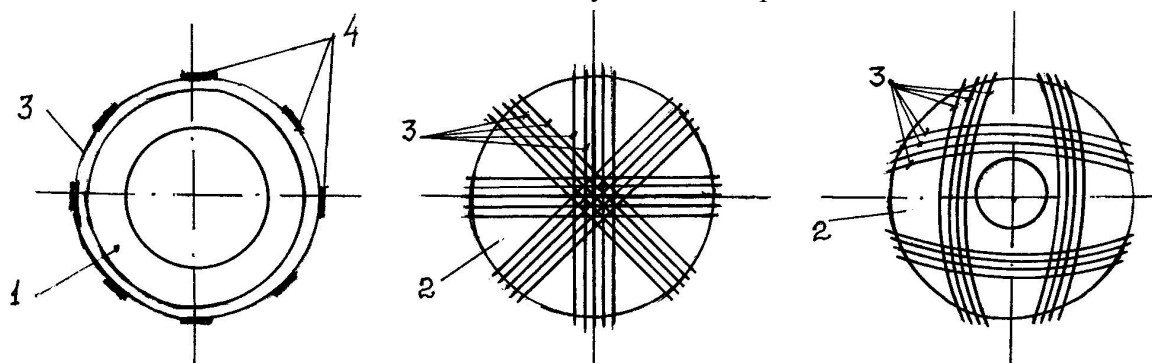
Схемы расположения напрягаемой арматуры фундаментных плит: 1 – кольцевая фундаментная плита; 2 – сплошная фундаментная плита; 3 – напрягаемая арматура; 4 – места анкеровки кольцевой напрягаемой арматуры
